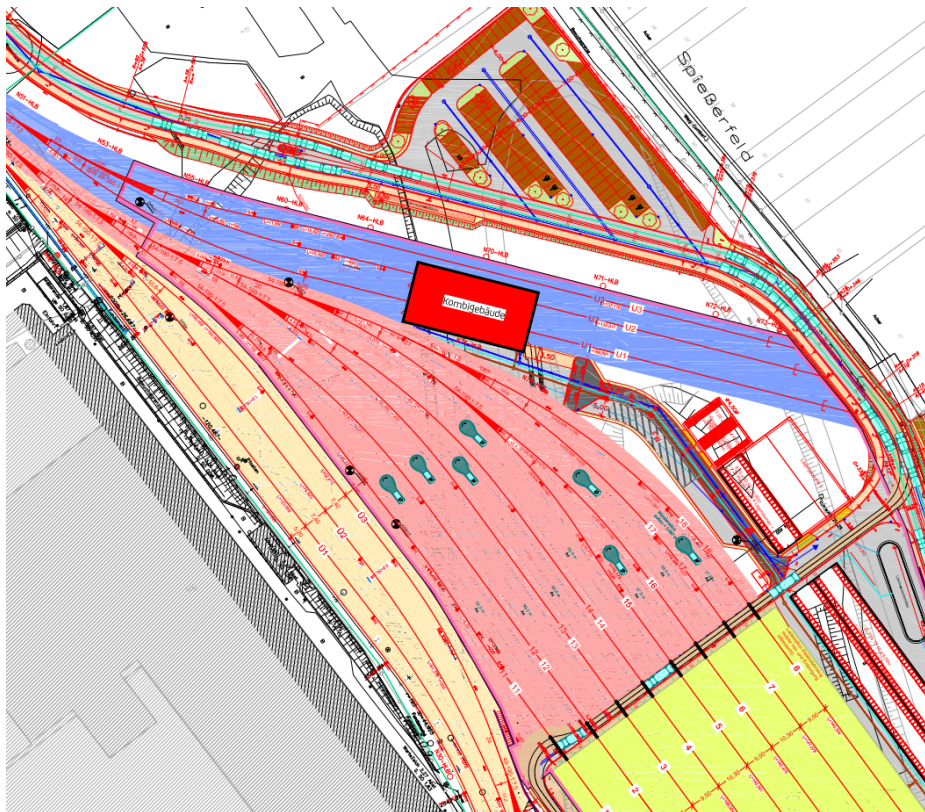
Ausschnitt aus dem /Lageplan/ mit Darstellung des Kombibehäudes (rot)
